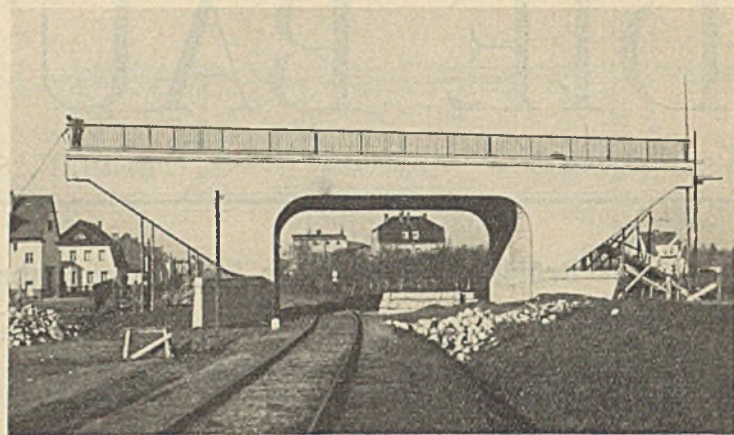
Kleinbahnunterführung unter der Verbindungsbahn Scheune—Altdamm.
